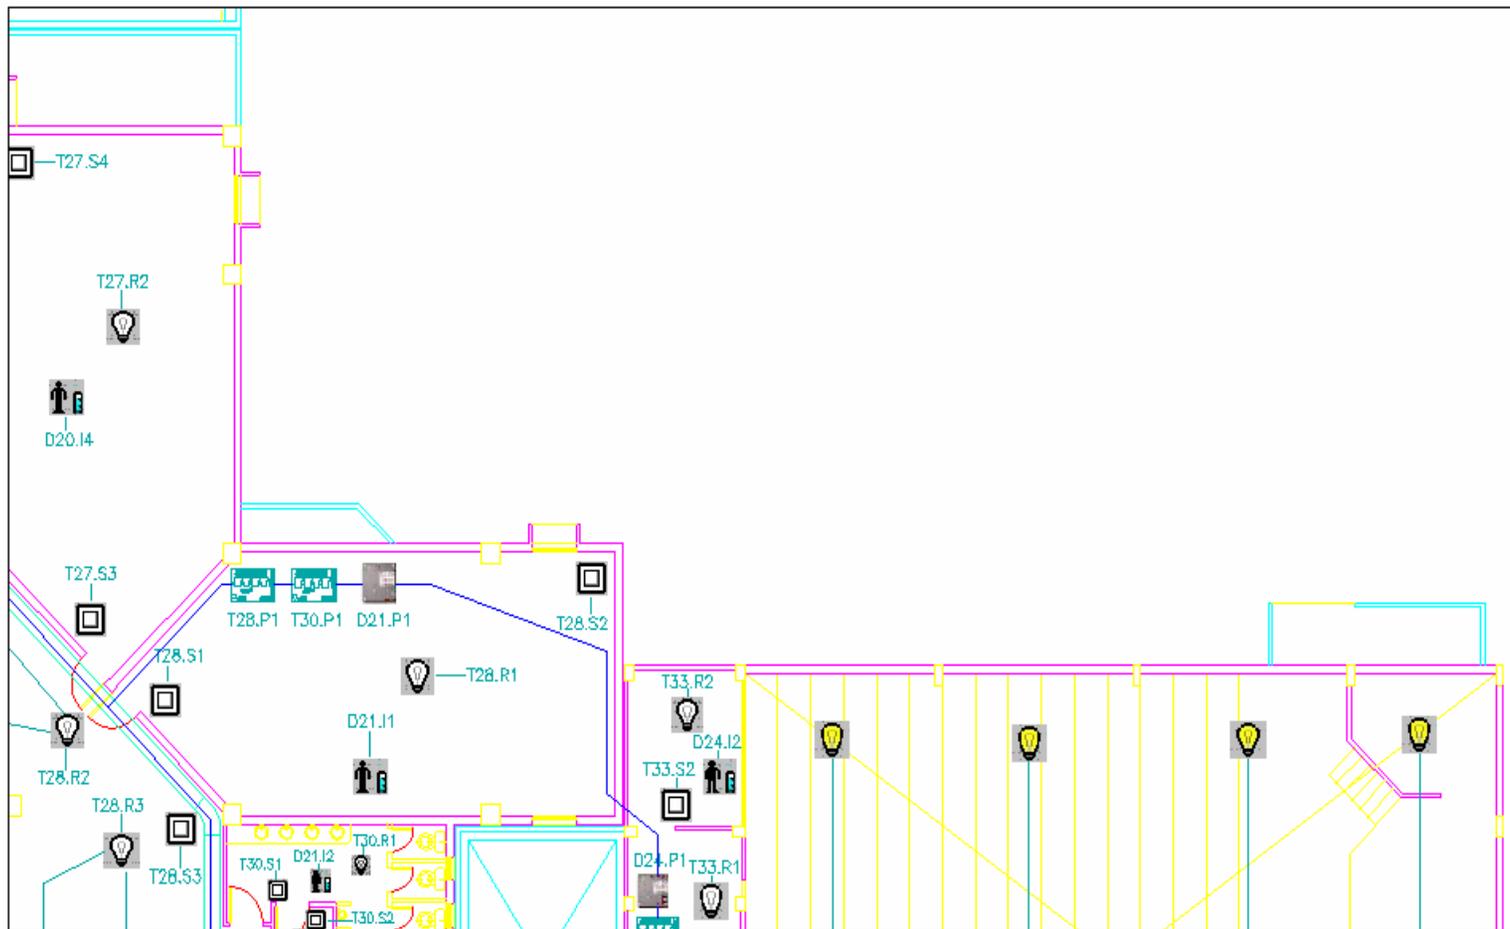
PLANO ILUMINACION PRIMER PISO SECCION 4
